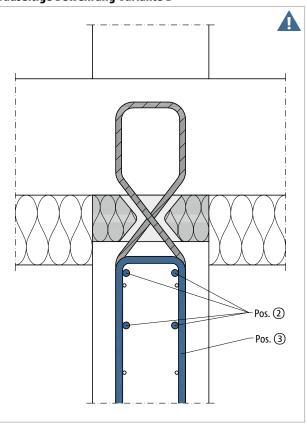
Schöck Sconnex® Typ W-N-VH: Bauseitige Bewehrung Variante B; der Stabstahl Pos. 2 stützt die Querkraftstäbe des Schöck Sconnex® gegen das Innere des Stahlbetonbauteils ab
